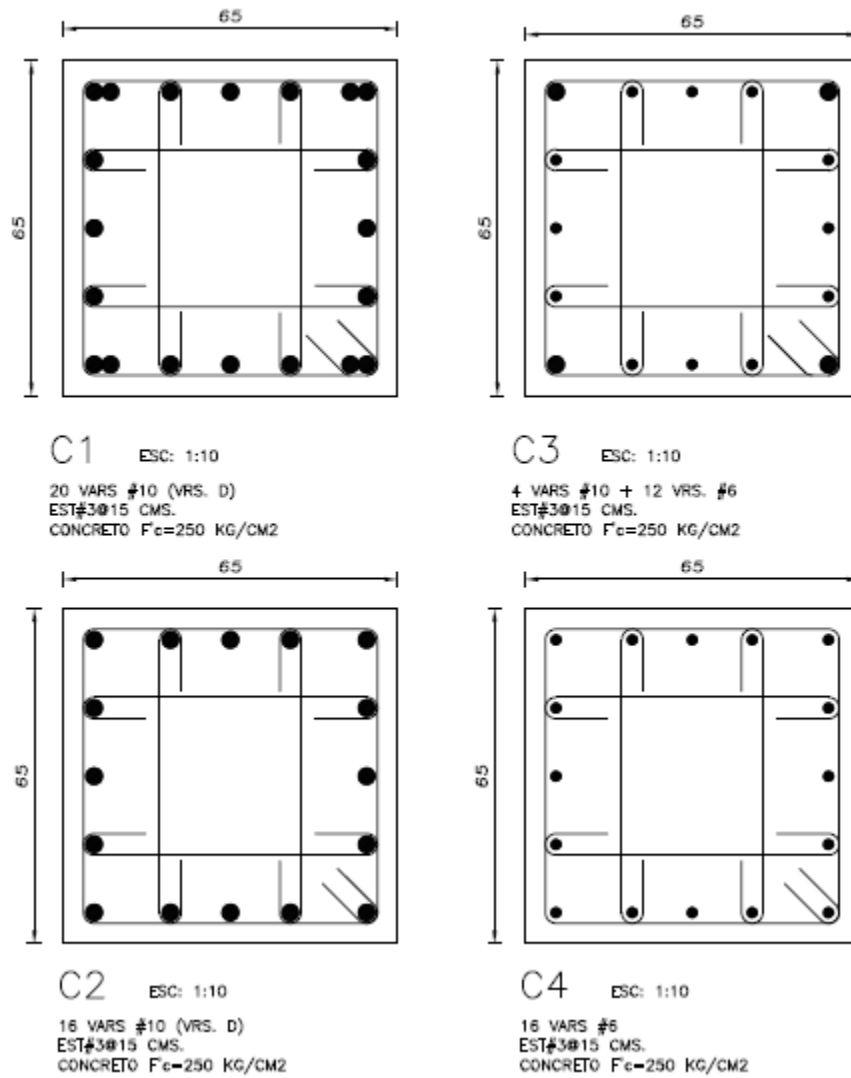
Armado tipo en las columnas de prototipo base fija
